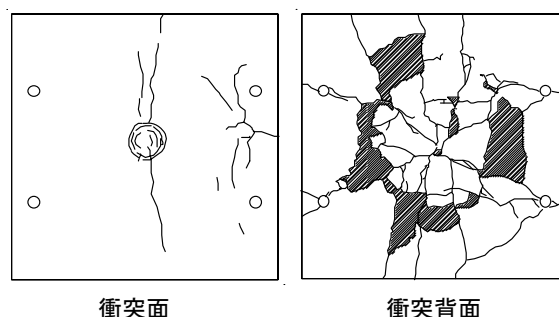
実験終了時の RC 版の破壊状況 (No.3 試験体)
